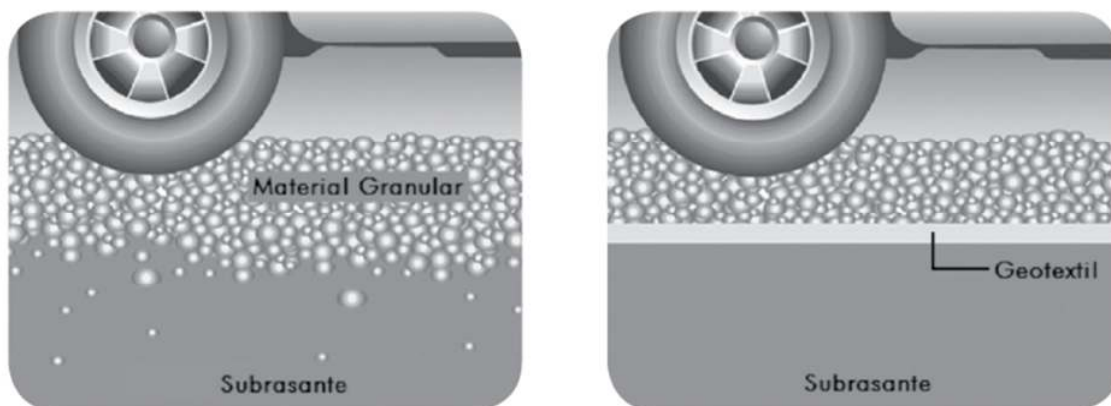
Sustitución de una sección transversal de una estructura de pavimento con geotextil [5].
